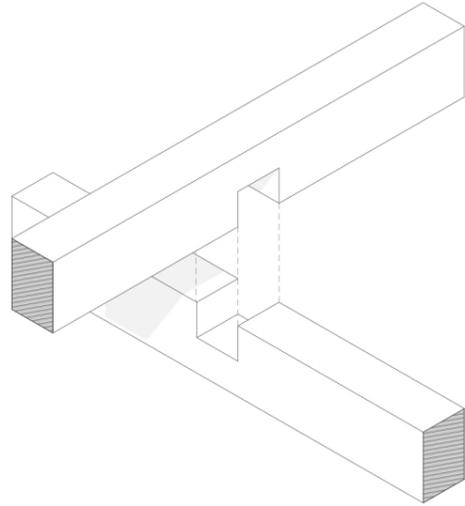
Detalle unión de vigas. Fuente: Elaboración propia
